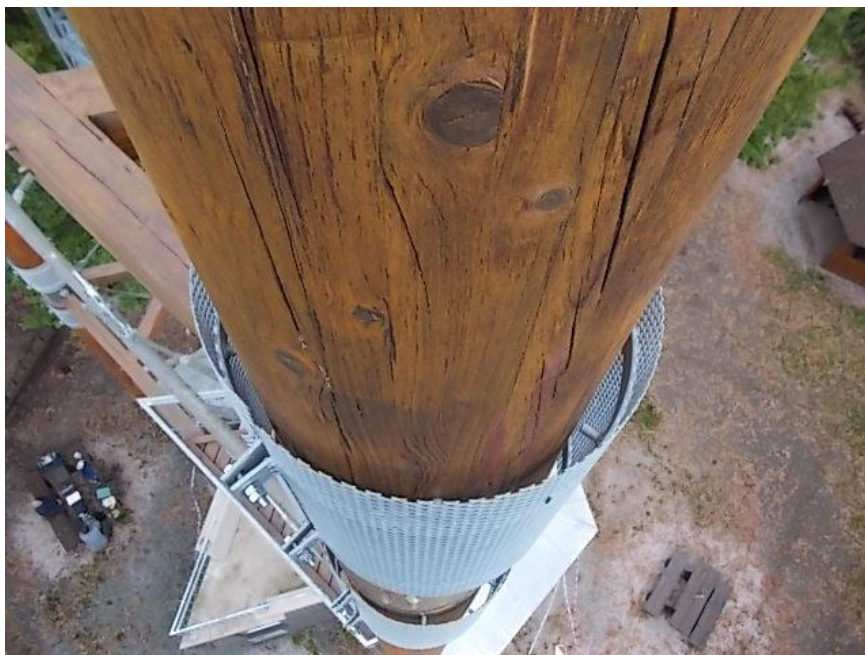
Sloup č. 1, díl D, foto zachycuje současný stav povrchu sloupu - zachycena totální destrukce lakového nátěru, výsušné trhliny i počátek povrchové delaminace.
